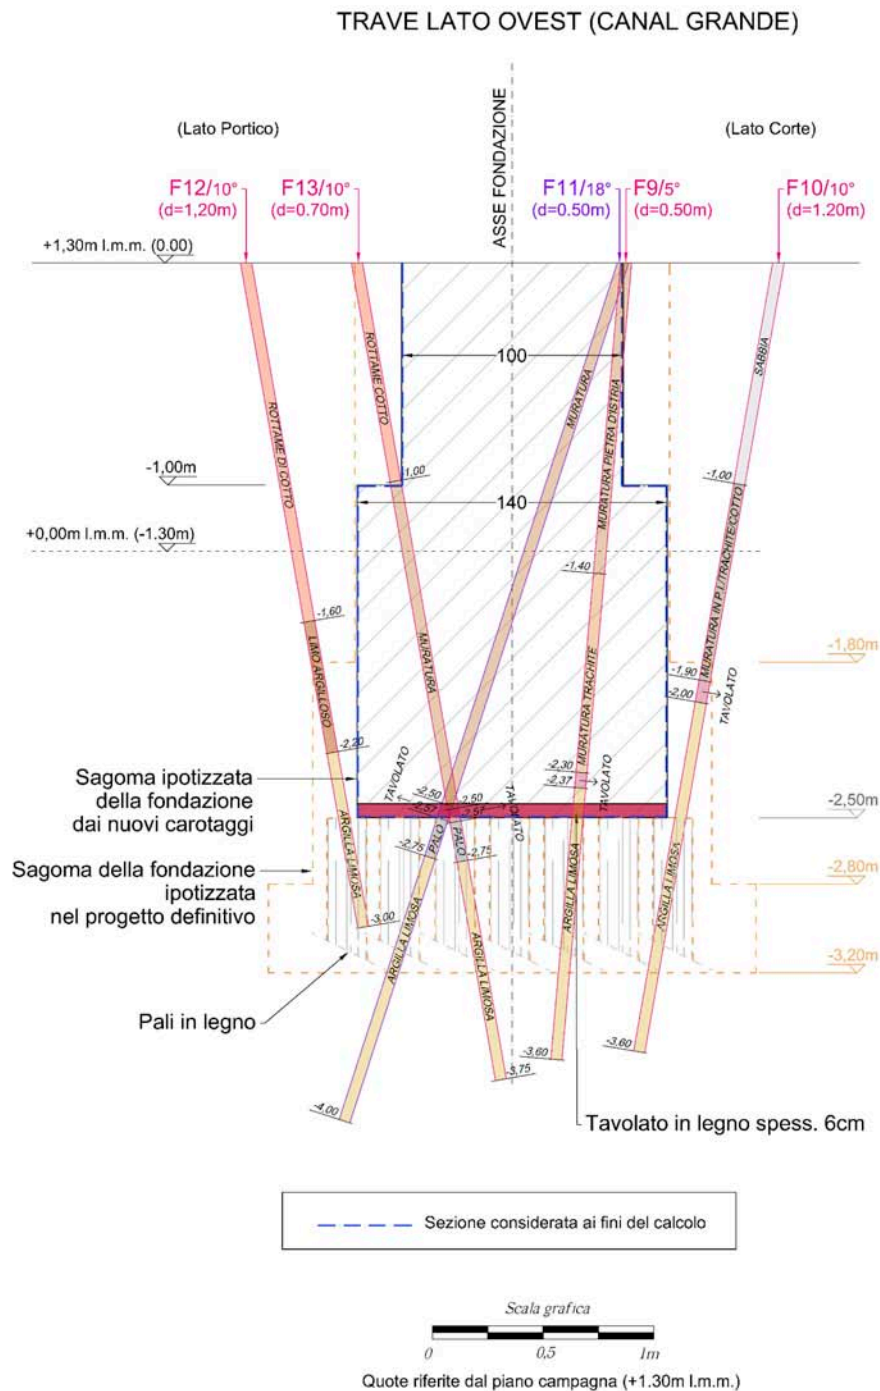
Restituzione delle fondazioni esistenti lato Ovest
